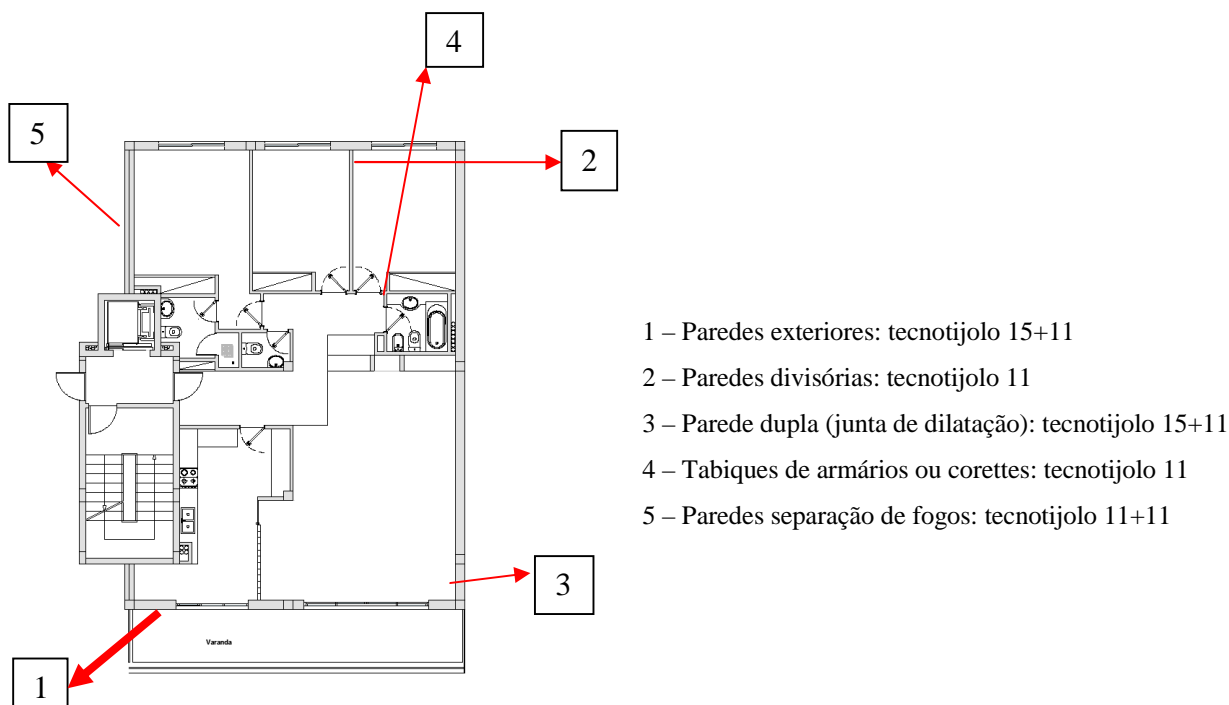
Planta (Fonte Própria, Fevereiro, 2009).
